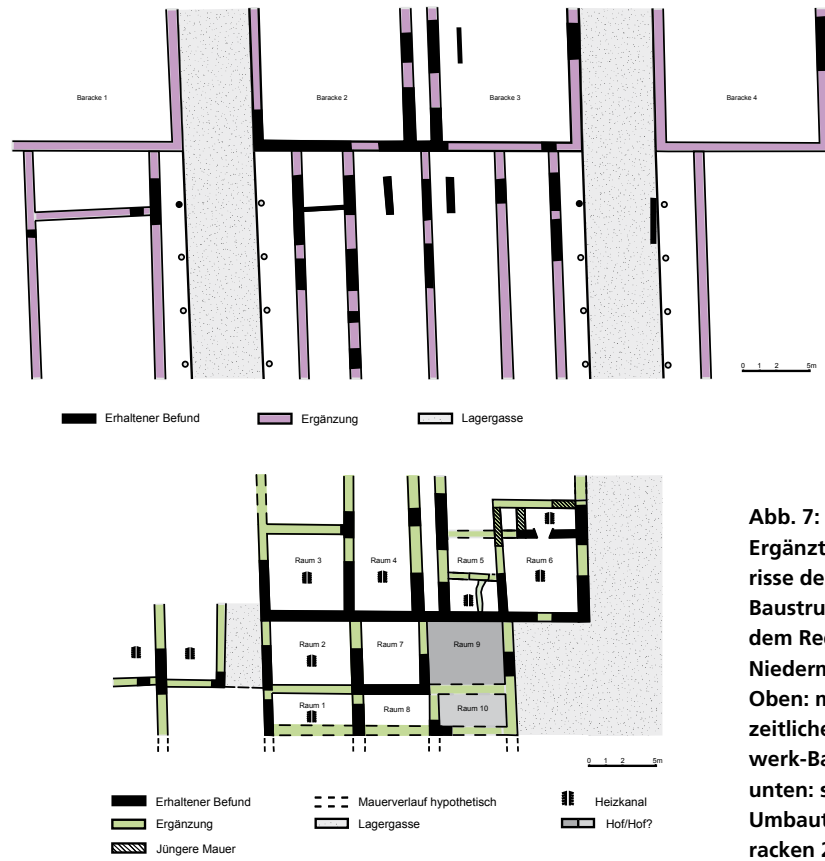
Ergänzte Grundrisse der römischen Baustrukturen unter dem Regensburger Niedermünster. Oben: mittelkaiserzeitliche Stein-Fachwerk-Baracken (lila); unten: spätantike Umbauten in den Baracken 2 und 3 (grün).
